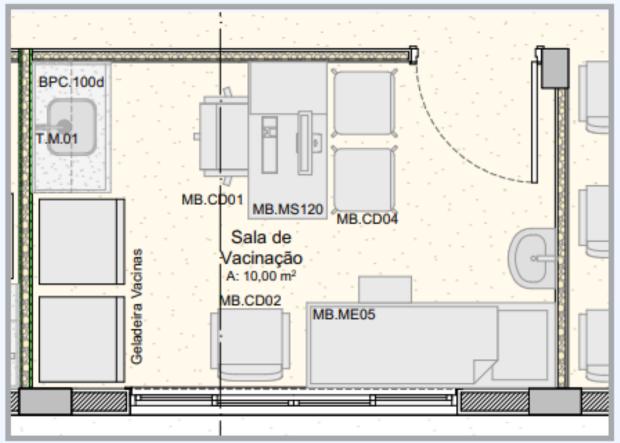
Planta de layout Sala de Vacinação – UBS Porte IV Novo PAC
